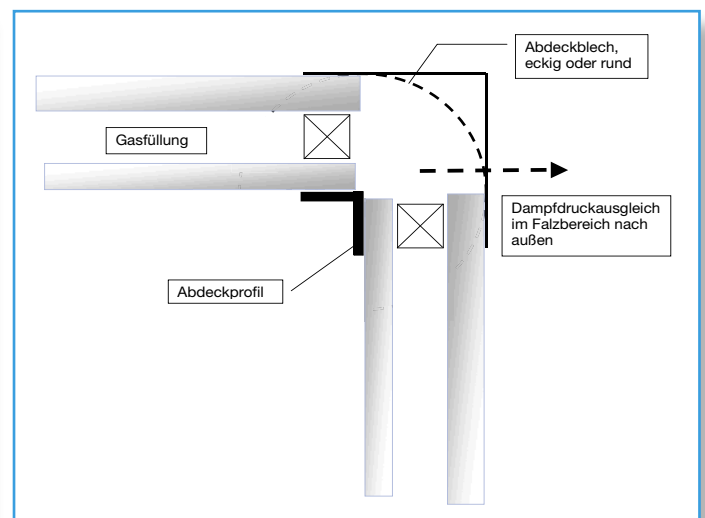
Isolierglas-Außenecke ohne Rahmen: Diese Ausführungsvariante wird unter Verwendung eines Abdeckbleches hergestellt
